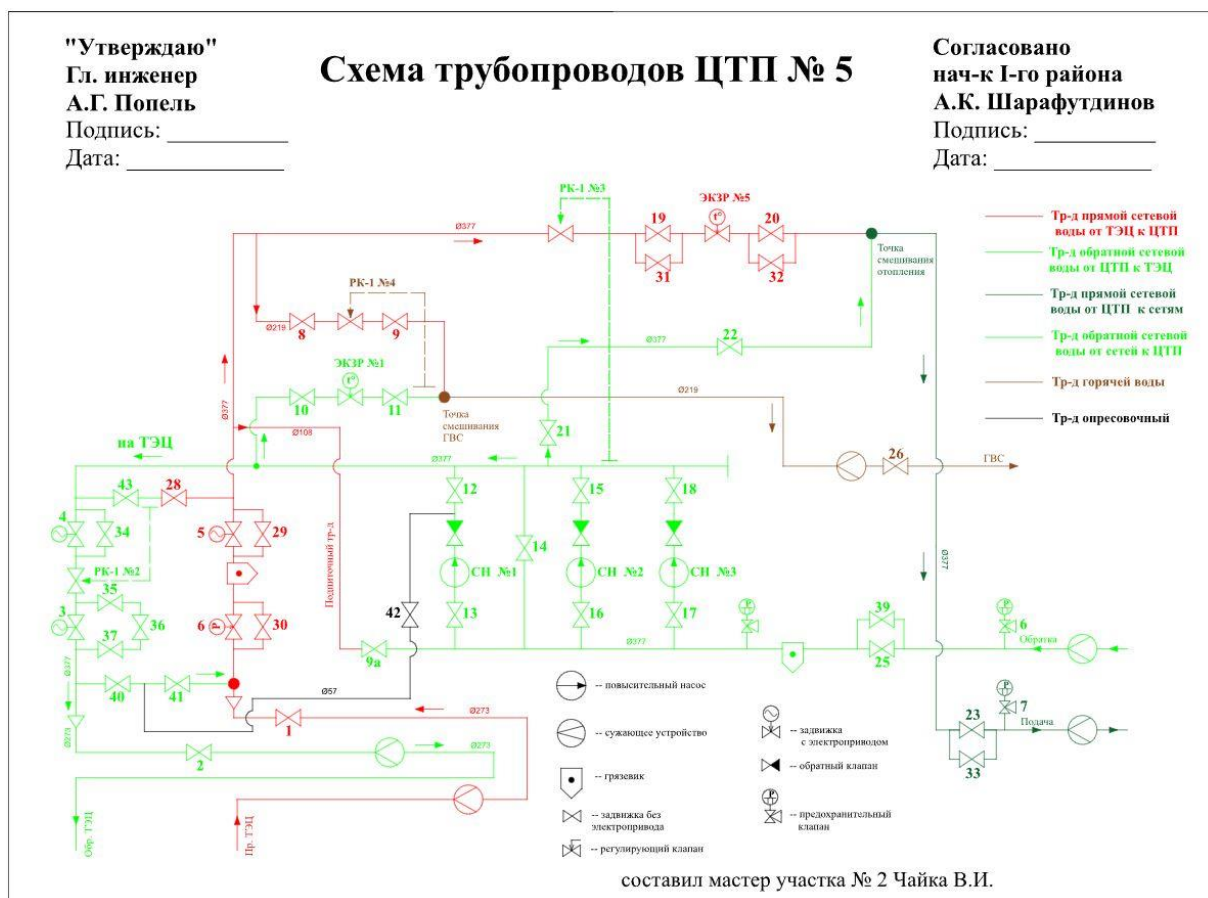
Схема трубопроводов ЦТП №5
